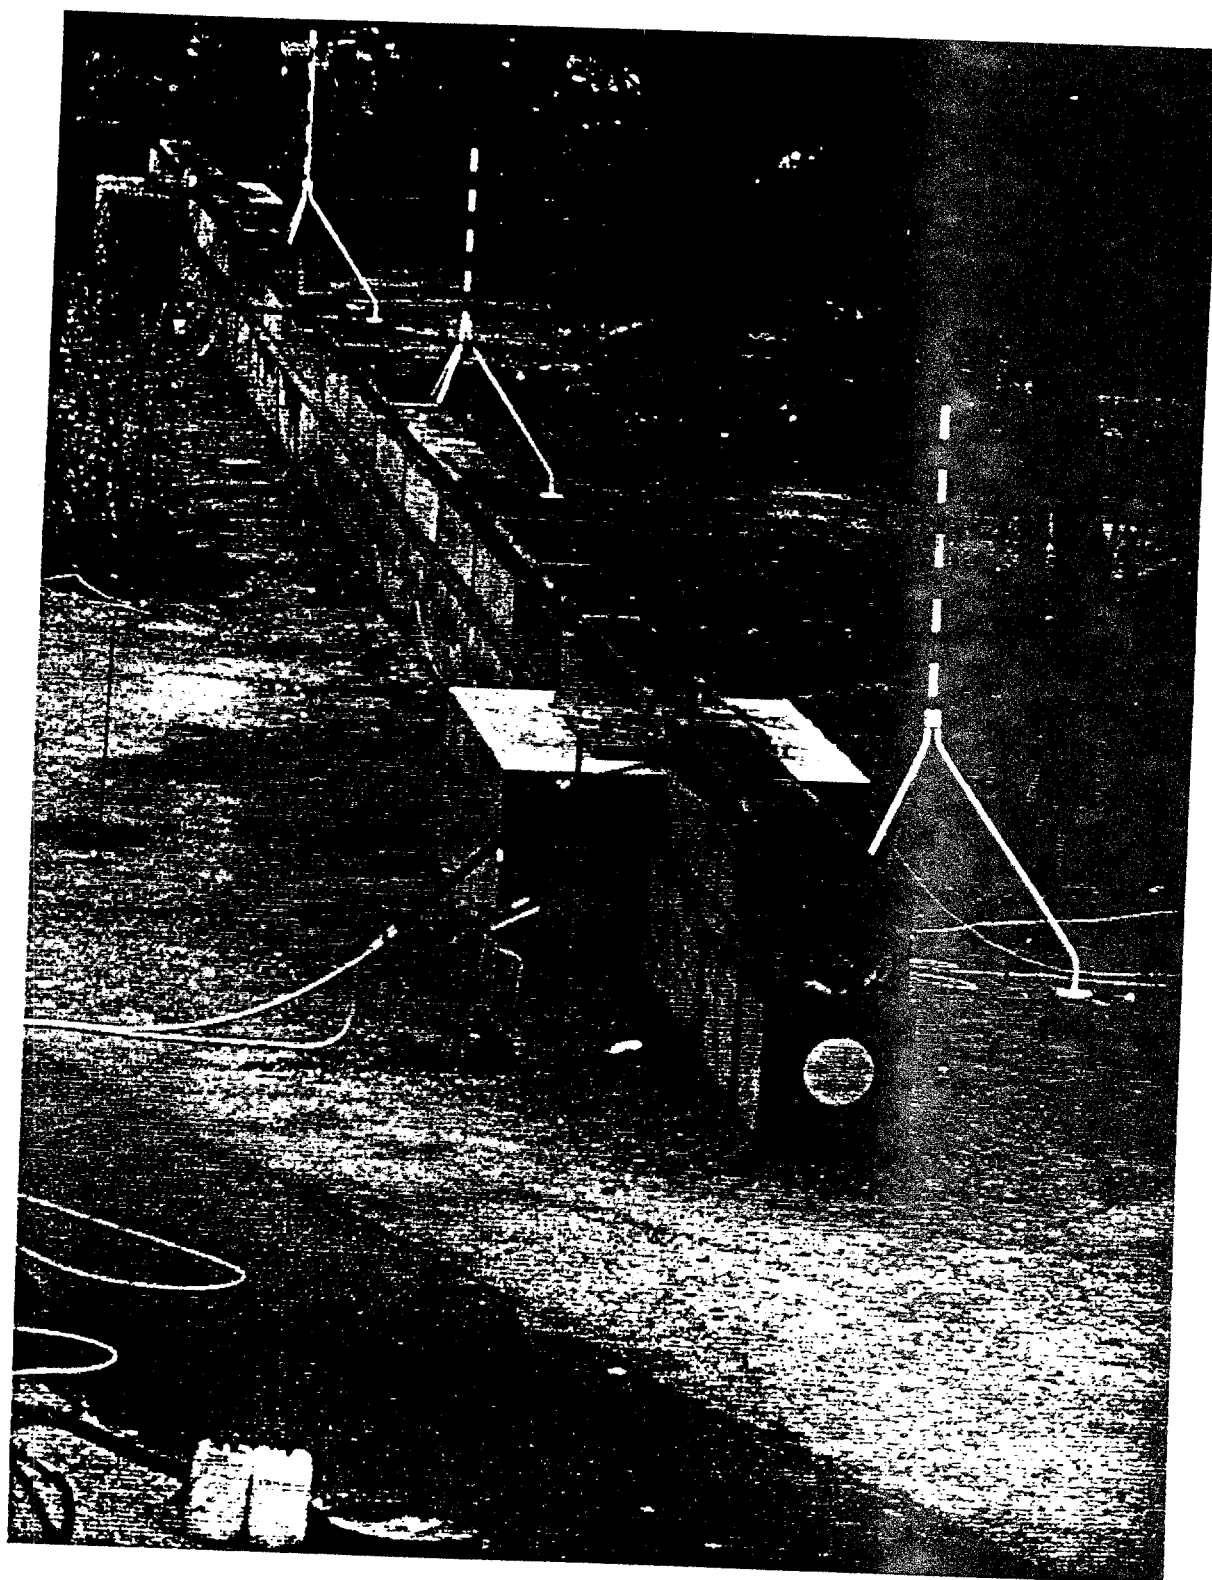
ELEMENT DE 70 m DE CANIVEAU - SIPHON - COLLECTEUR
